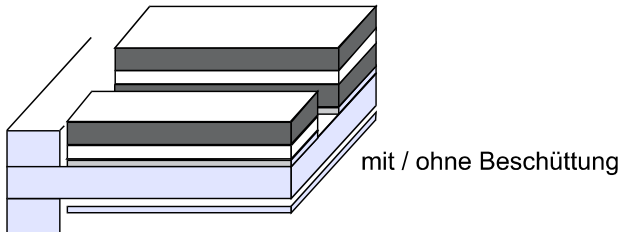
Schema Massivholzdecke mit Unterdecke und Fußbodenaufbau
